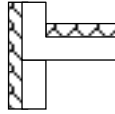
Exemple de toiture, vue en coupe - plancher haut
